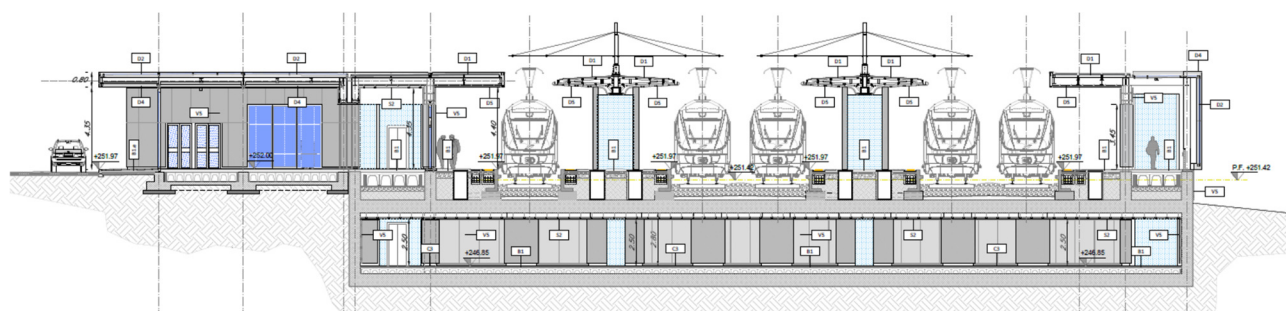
Sezione trasversale della stazione di Vigna di Valle
